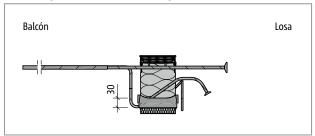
Schöck Isokorb® XT tipo K-U-M4: Sección del producto
